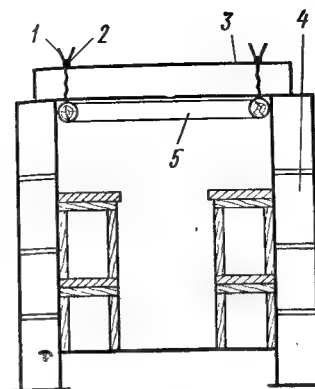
Поперечный разрез убежища, возводимого с использованием для стен бетонных блоков
